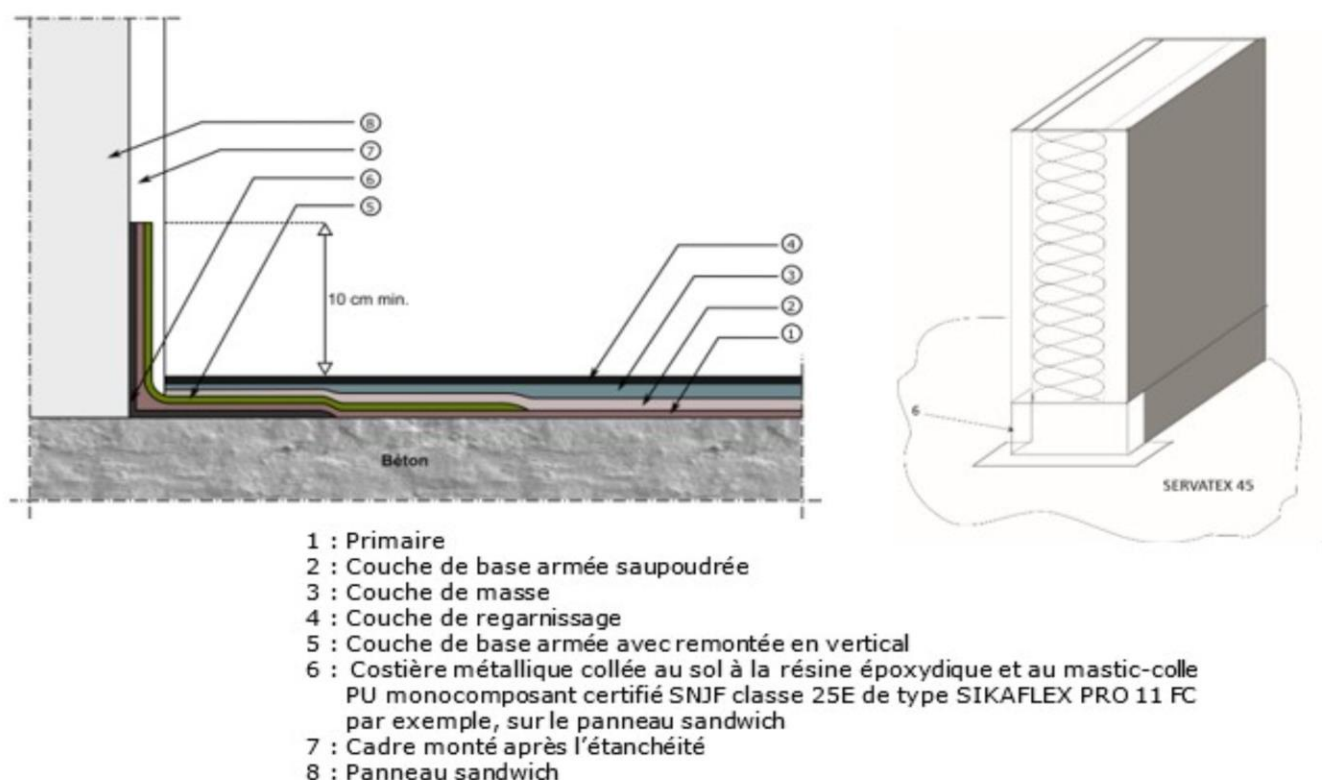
Traitement de la tête de cloison d'un panneau sandwich
